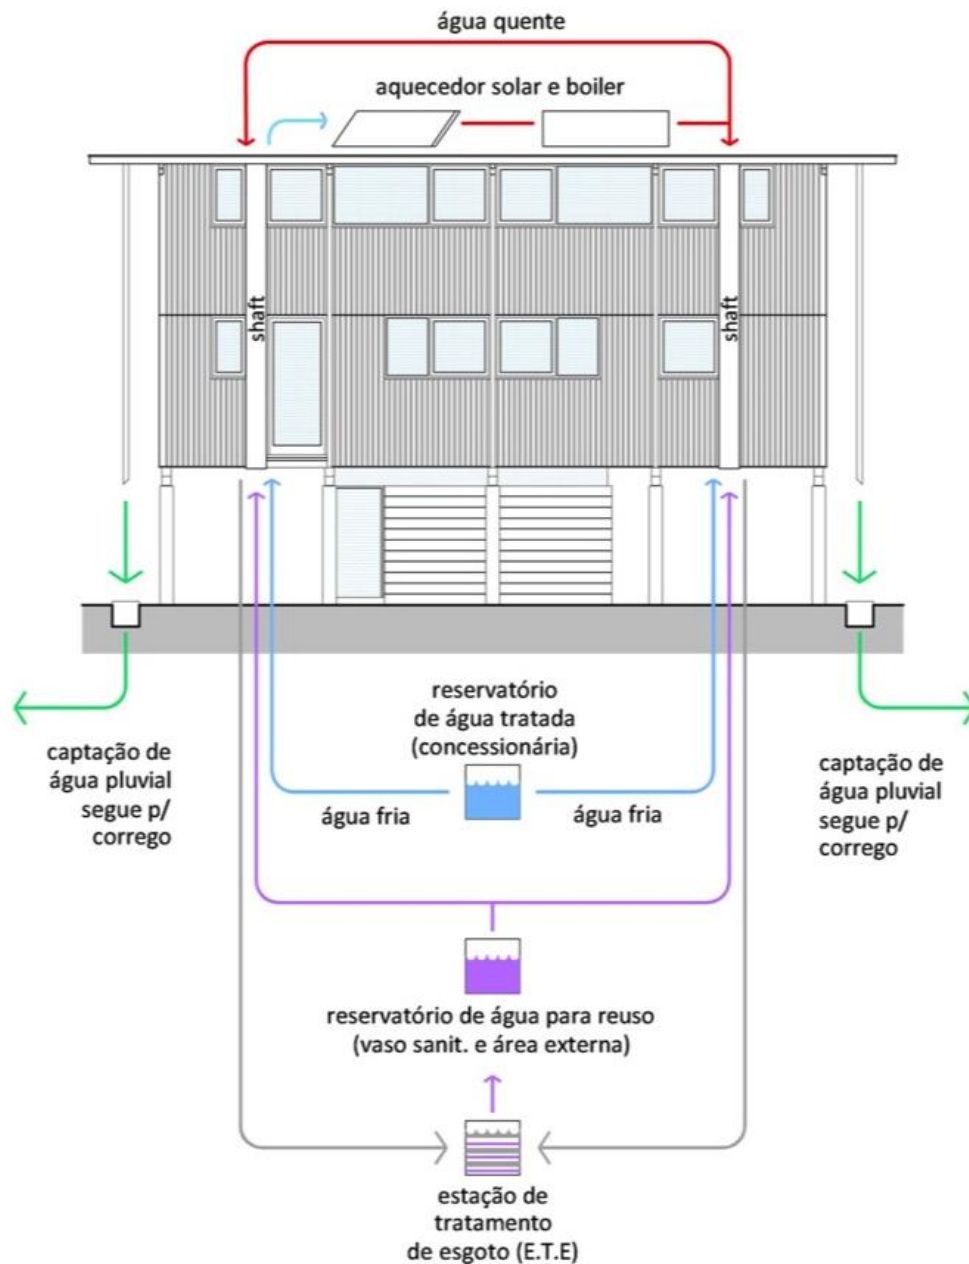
CASA TIPO 1, ELEVAÇÃO ENTRADA PRINCIPAL
